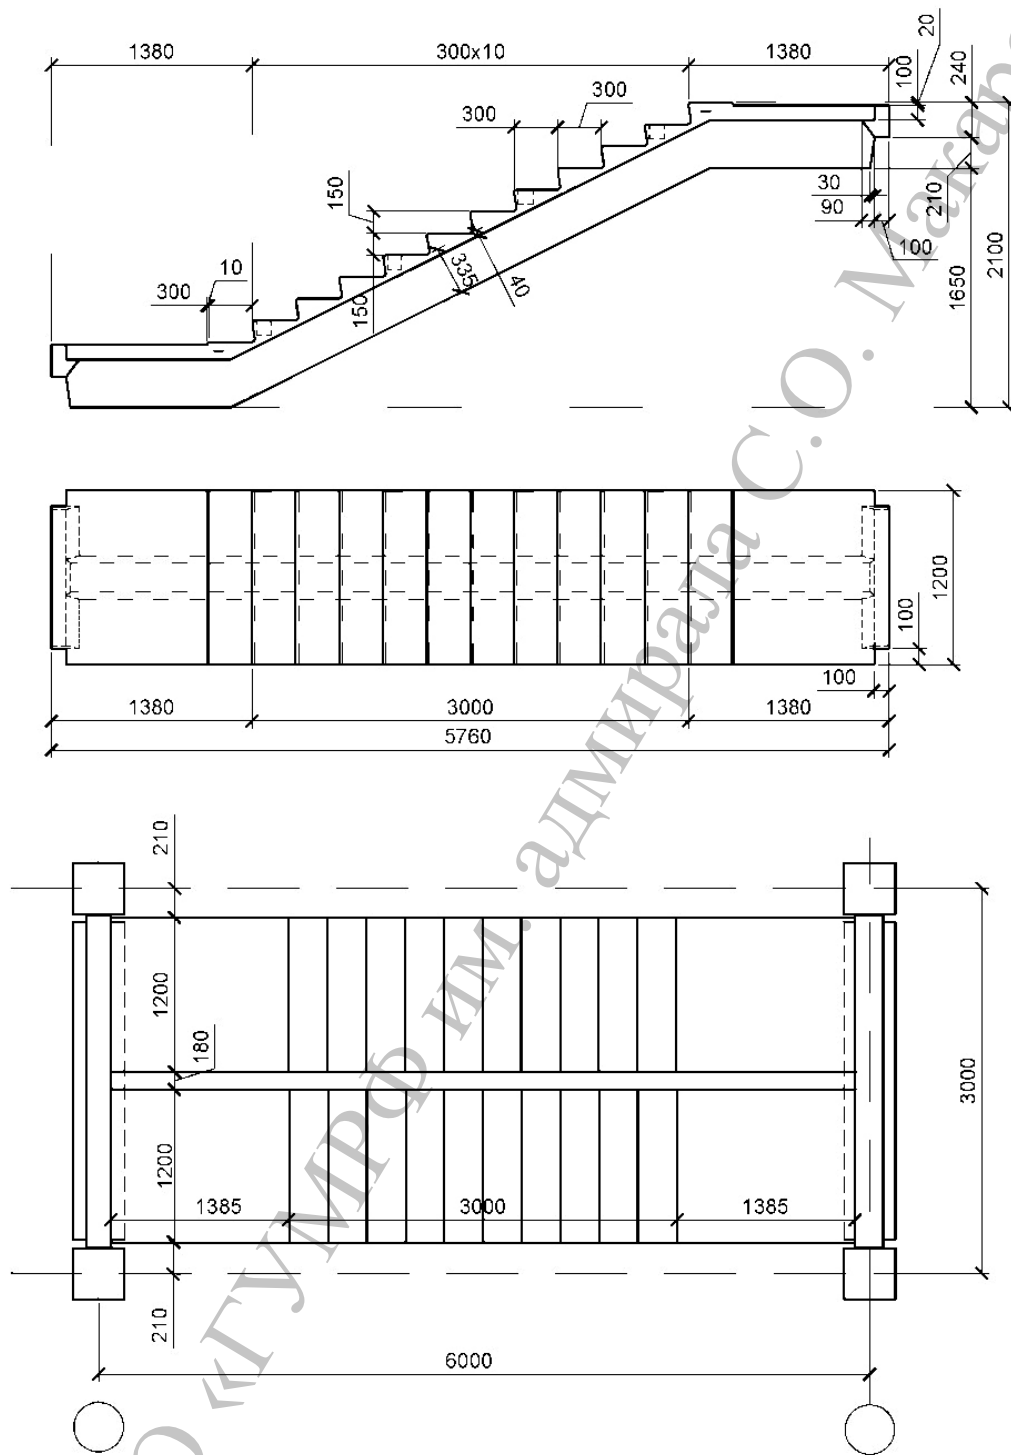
Лестница железобетонная в каркасном здании ЛМР-58.17.12
